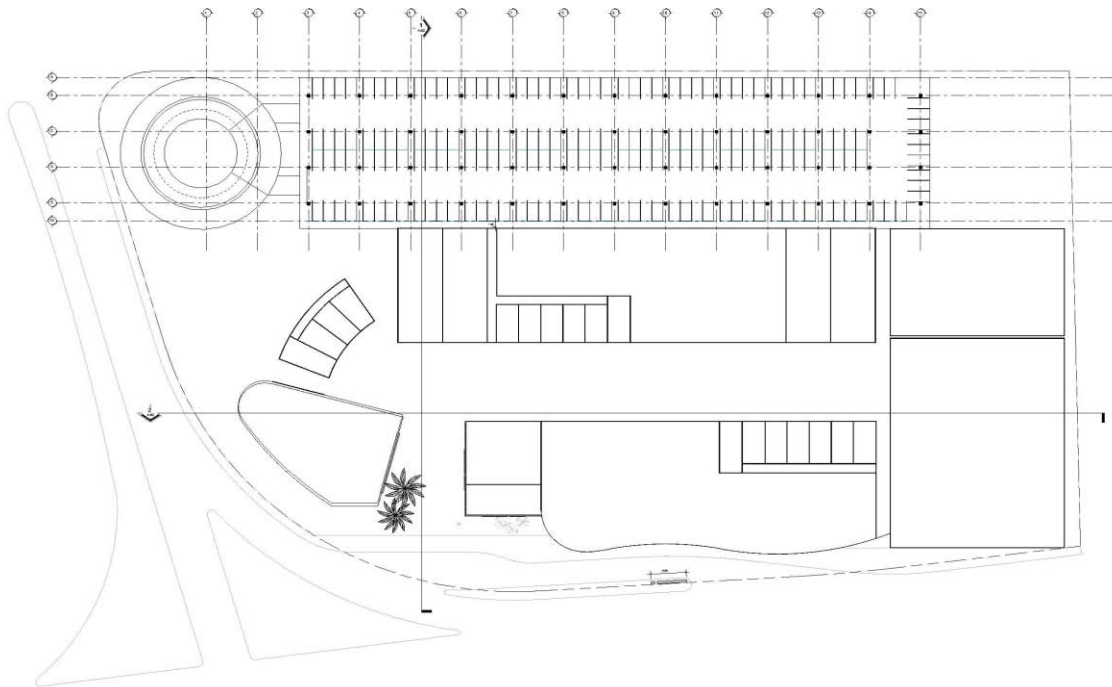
PLANTA DE ESTACIONAMIENTO SEGUNDO NIVEL
